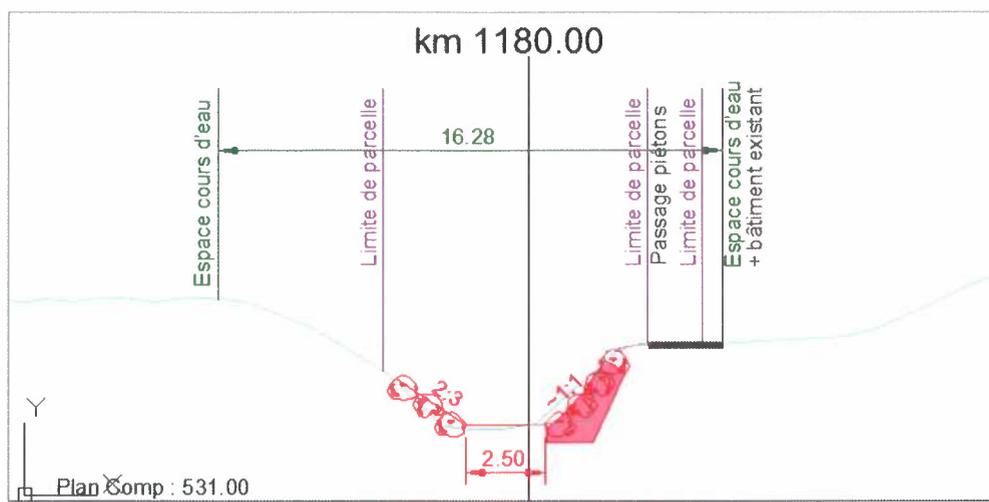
Profil type d'aménagement de la Rèche au niveau de l'Impasse de la Cascade
